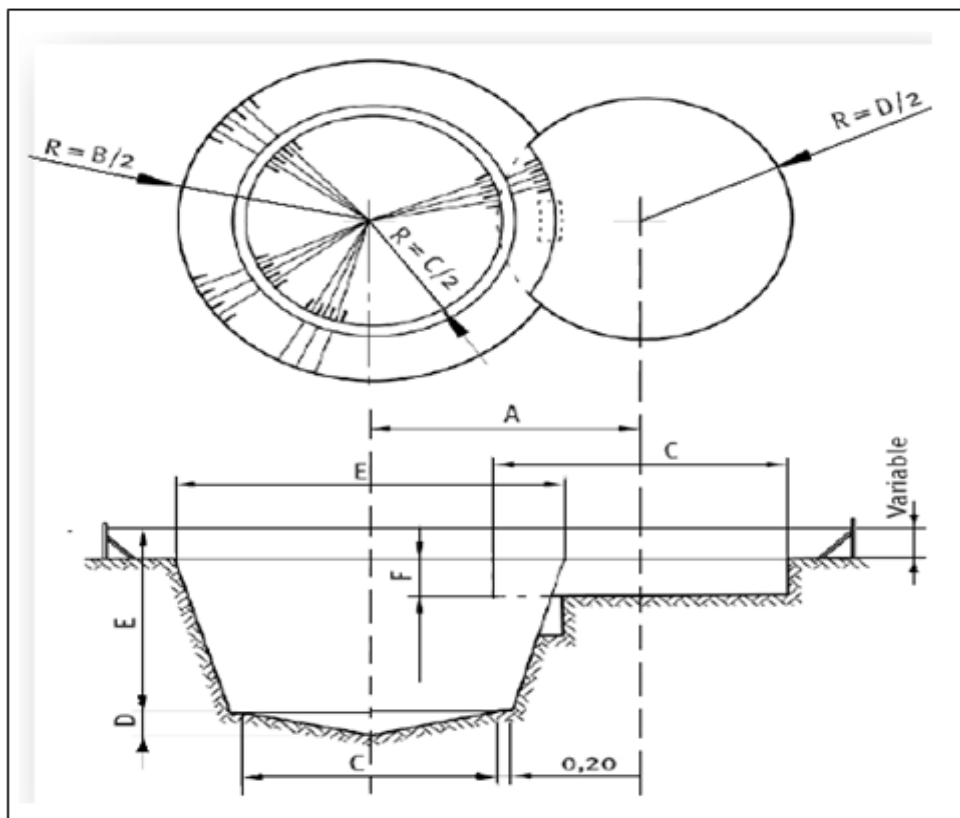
Planta y corte de la excavación para biodigestores típicos del tipo Nicarao, desde 12 hasta 42 m³
